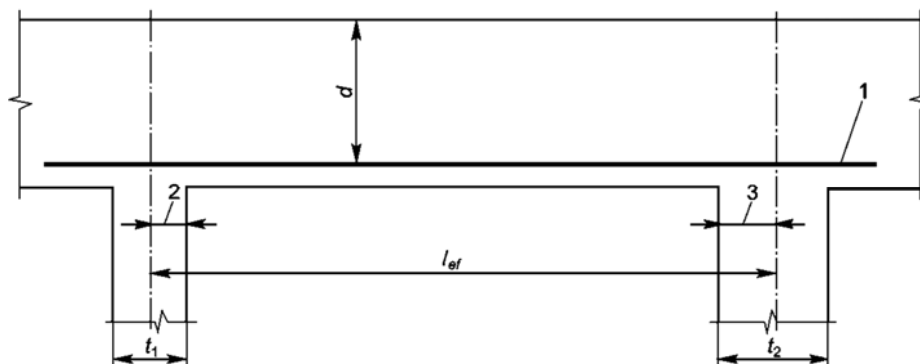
Расчетный (эффективный) пролет однопролетной или неразрезной балки:
